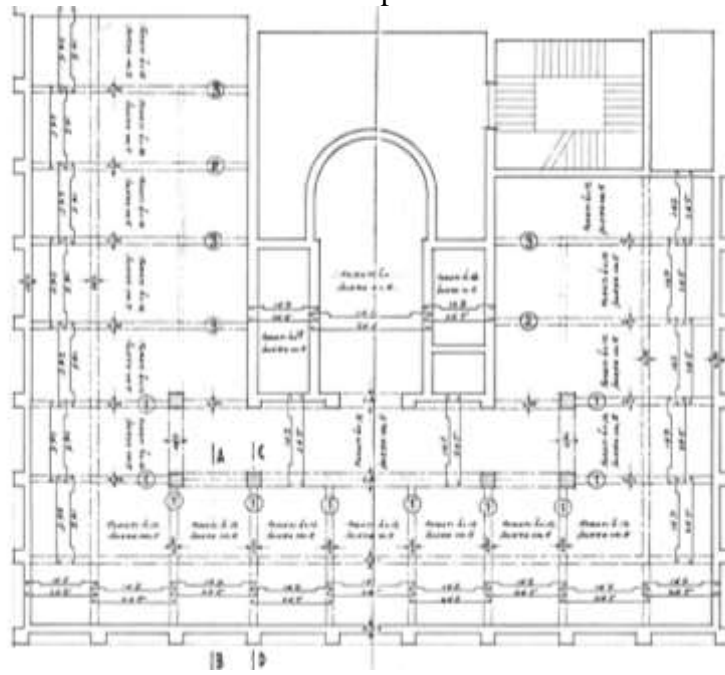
Pianta solaio di copertura piano terzo (da progetto preliminare), con indicazione delle travi in c.a.
